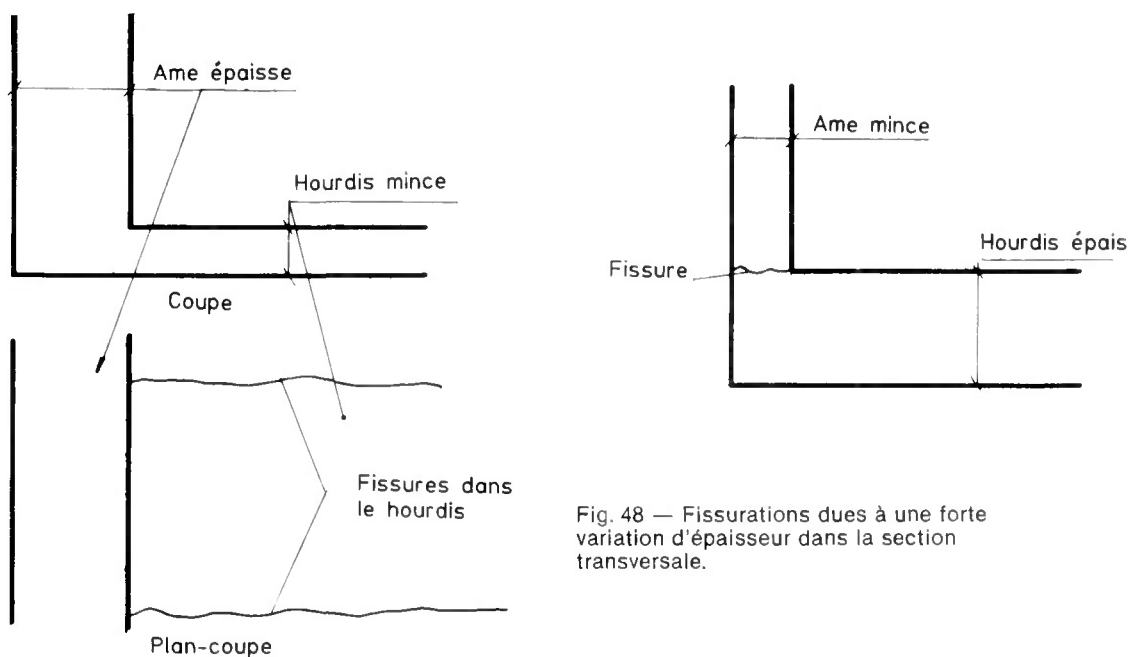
Fissurations dues à une forte variation d'épaisseur dans la section transversale.
